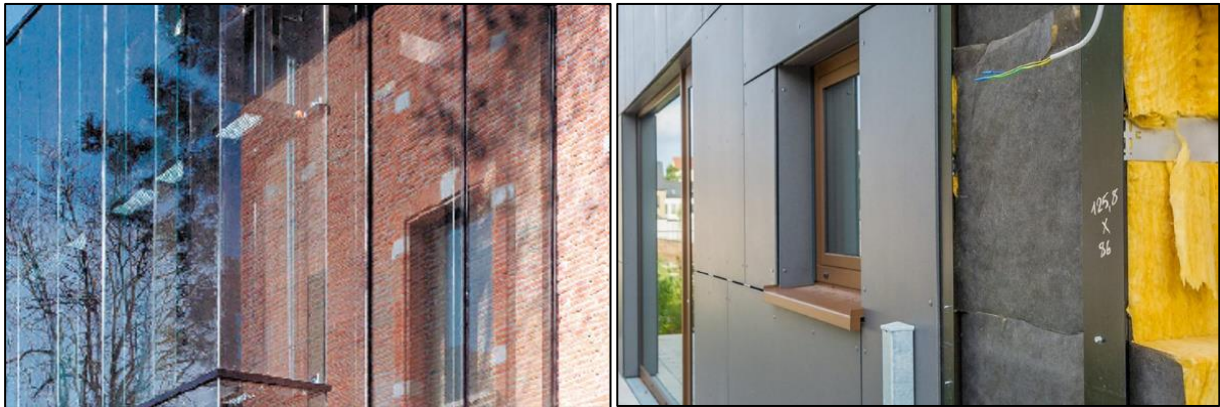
Exemples d'isolation par l'extérieur des façades, vitrée ou non, modifiant considérablement l'aspect architectural d'un bâtiment
